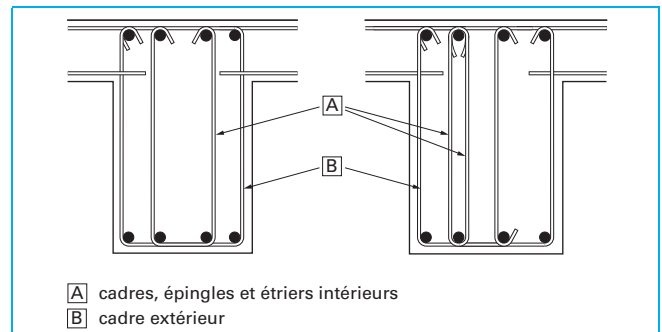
Armatures d'effort tranchant (figure 9.5 de l'EC2)
